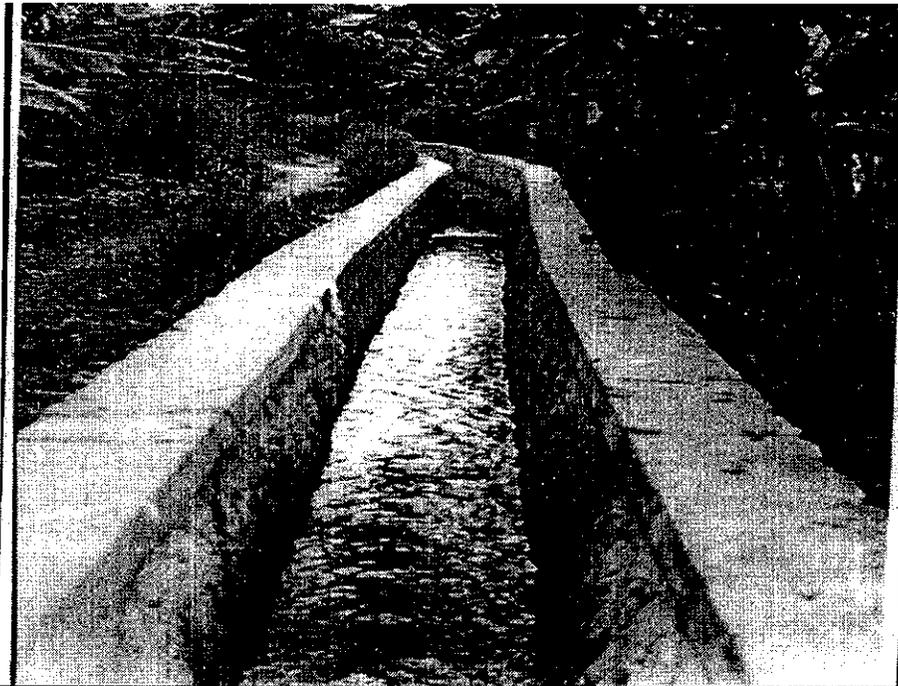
Vue d'un tronçon de canal construit à Cayes-Jacmel
